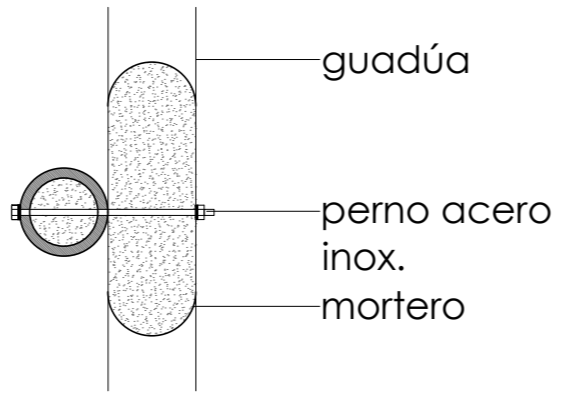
Detalle de Cubierta de Guadúa y Muros de Piedra
